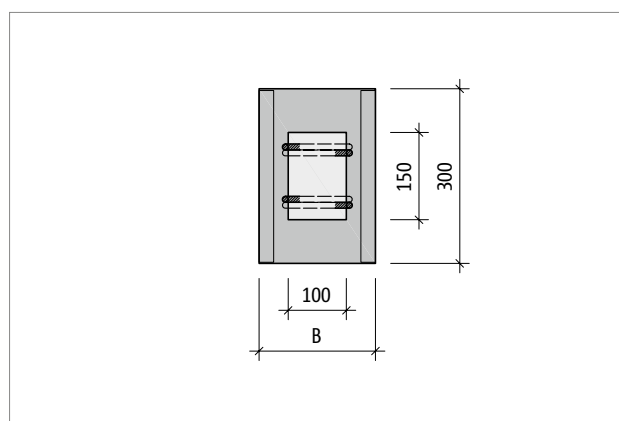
Schöck Sconnex® type W-N-VH: Variant B (voor dunne muren) - bijlegwapening; de langswapening ondersteunt de dwarskrachtstaven van Schöck Sconnex® tegen de binnenkant van het component uit gewapend beton.
